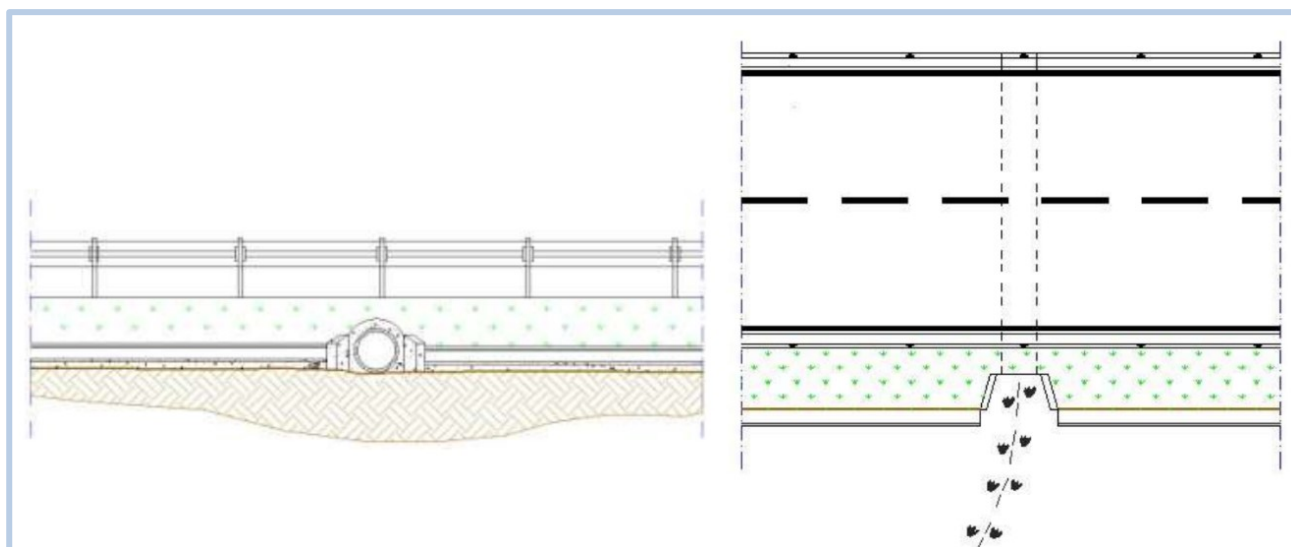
Sezione e Planimetria di un rospodotto (fonte: progetto ECONNECT, Pianezzola M. et al., 2011)
